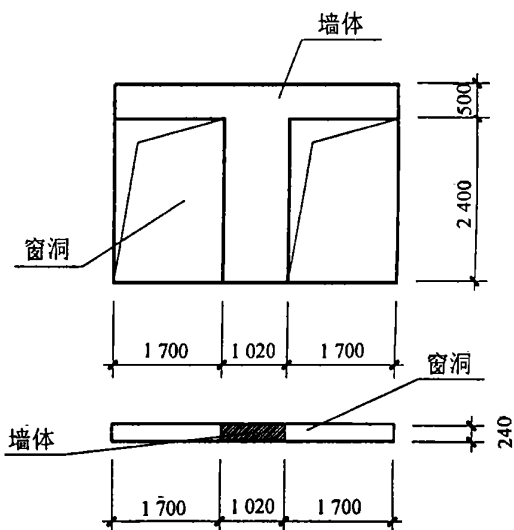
拆除计算单元墙体中窗下及窗与门洞间墙体的平、立面图
